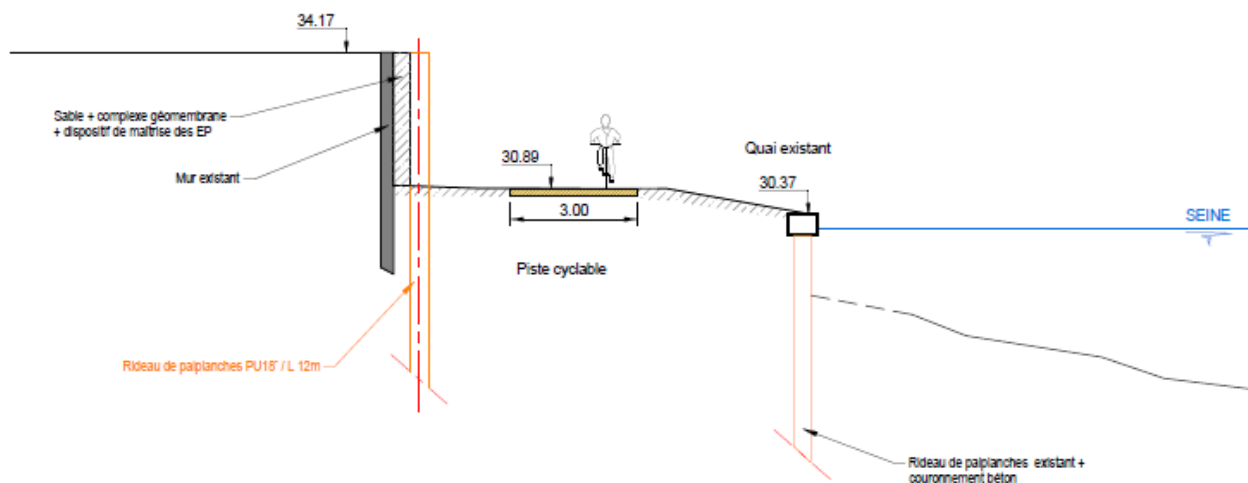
Extrait de plans présentant le projet de confortement du mur existant (source : Artelia)
